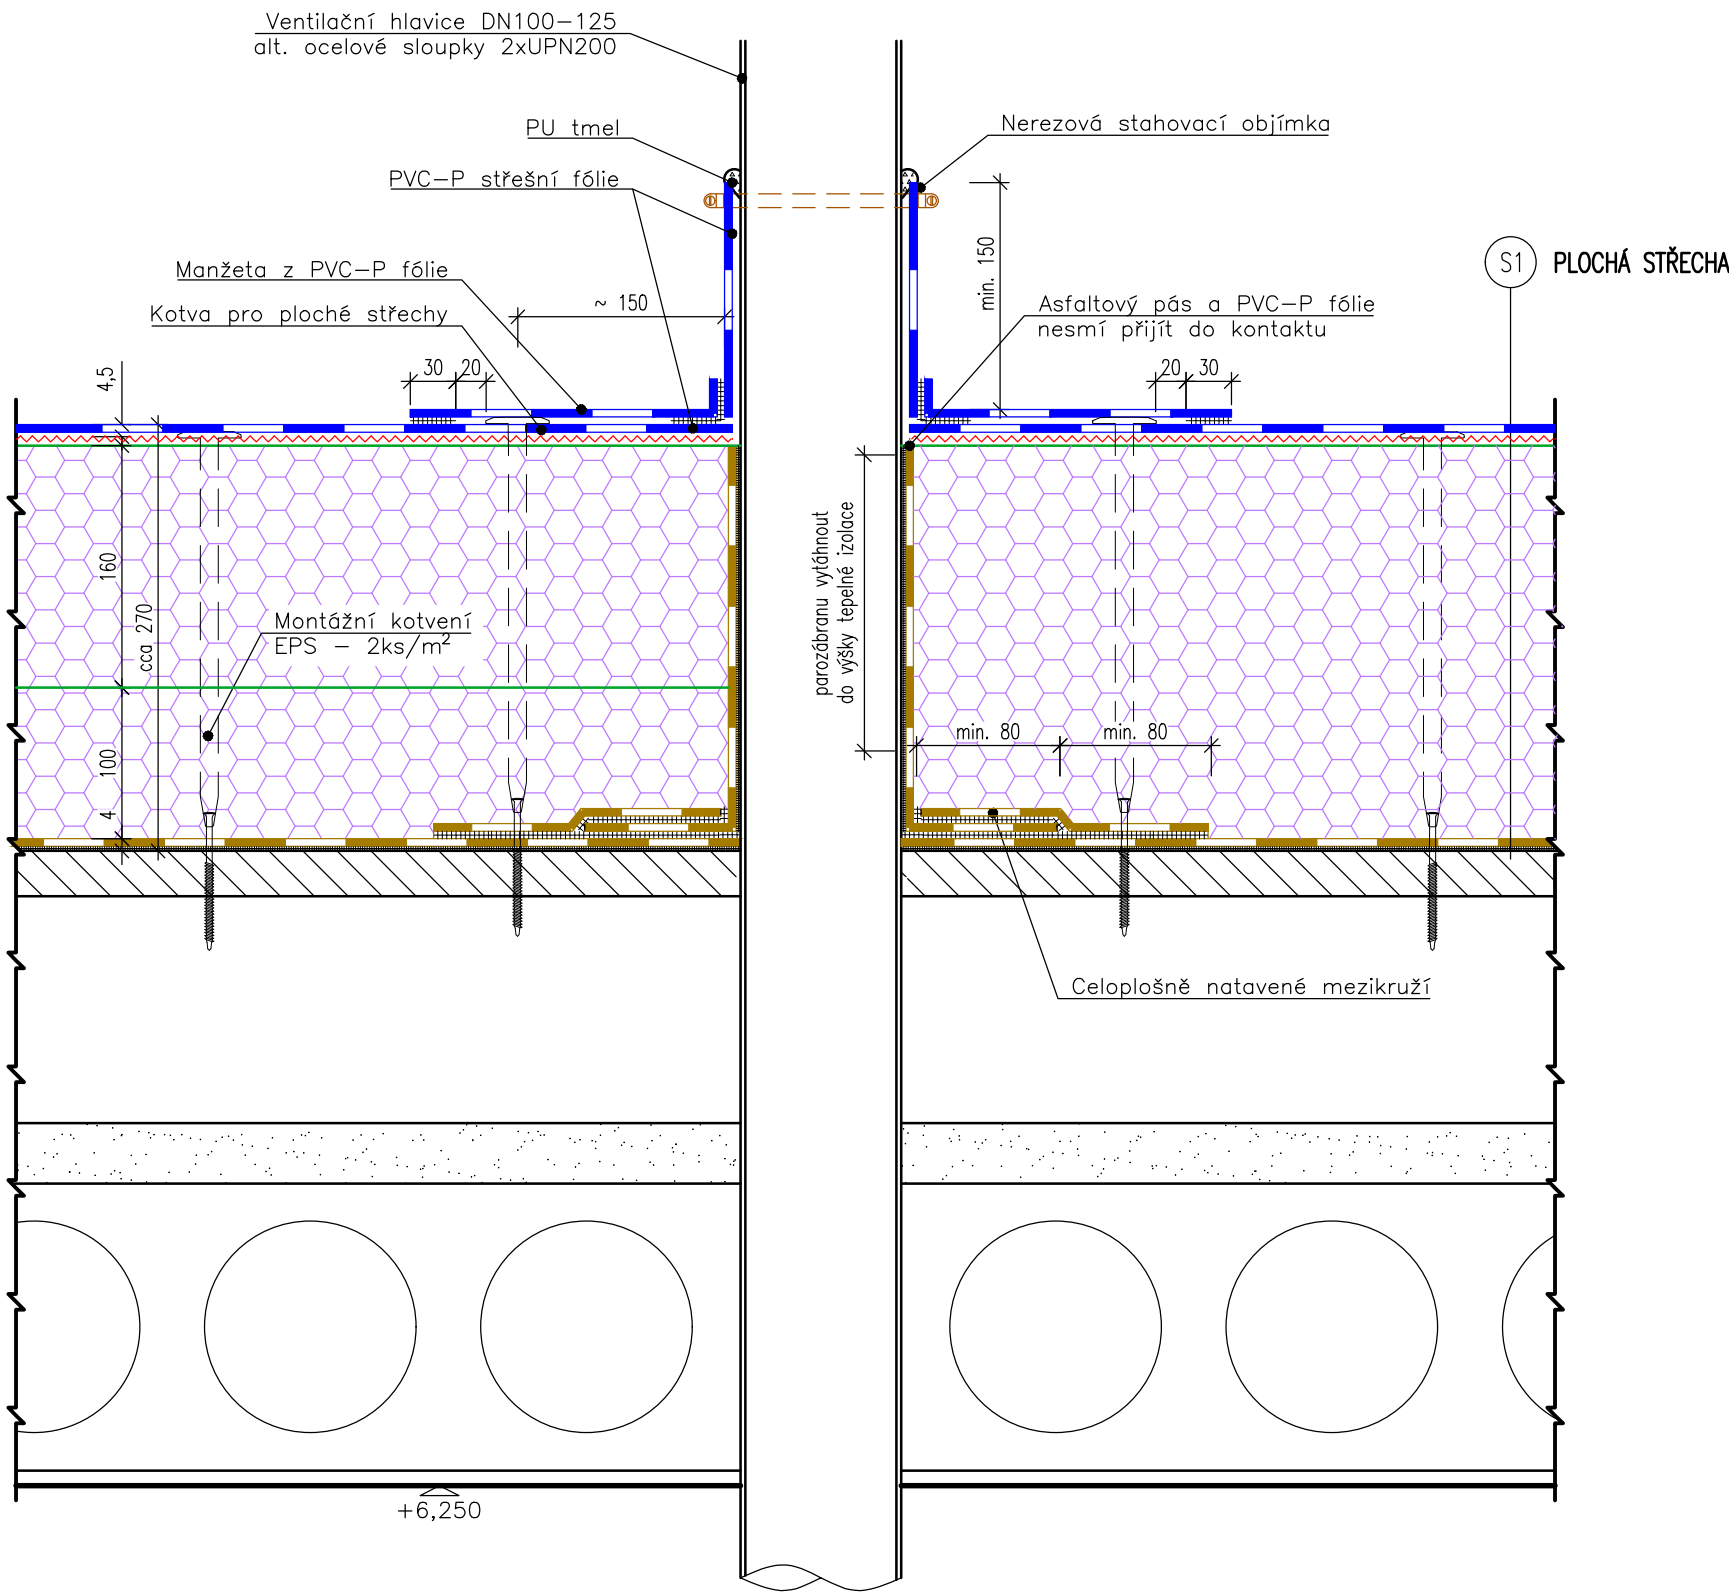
, 05 – DETAIL PROSTUPU STŘECHOU, M1:5
